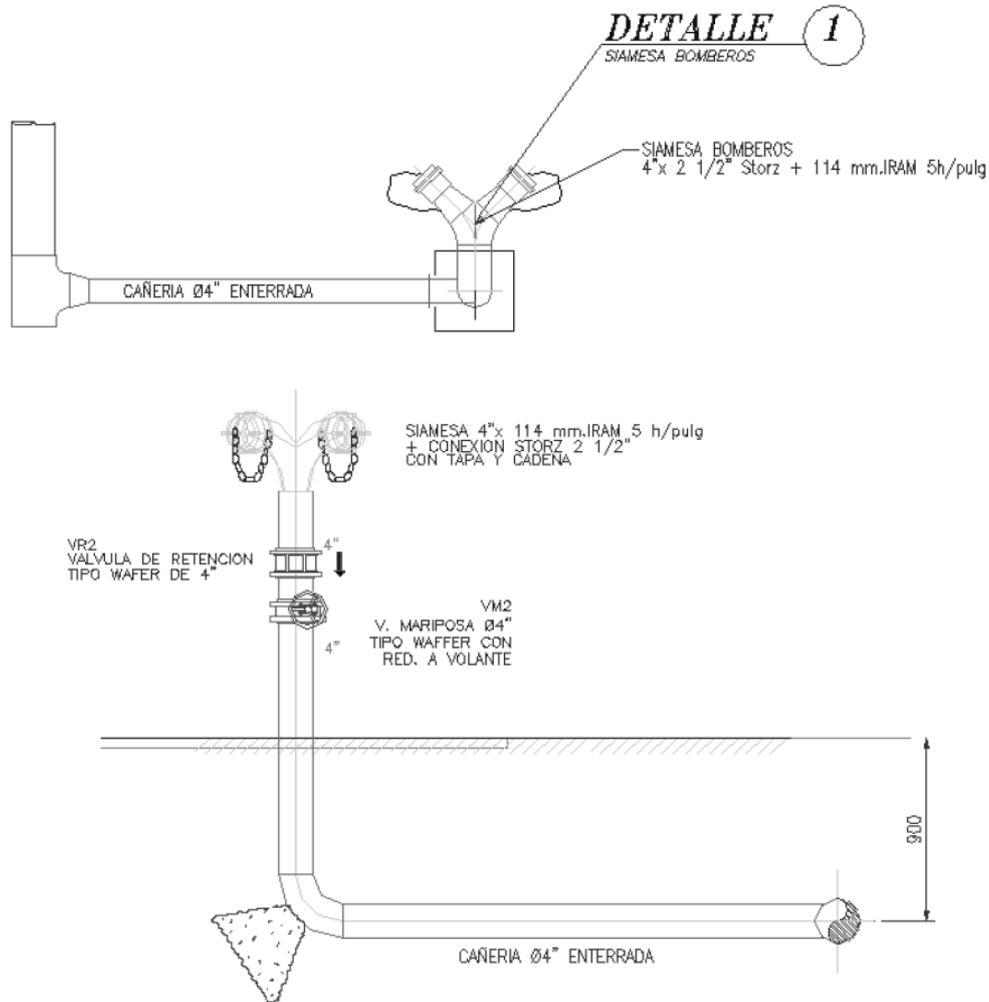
Detalle constructivo de boca de impulsión sobreelevada
